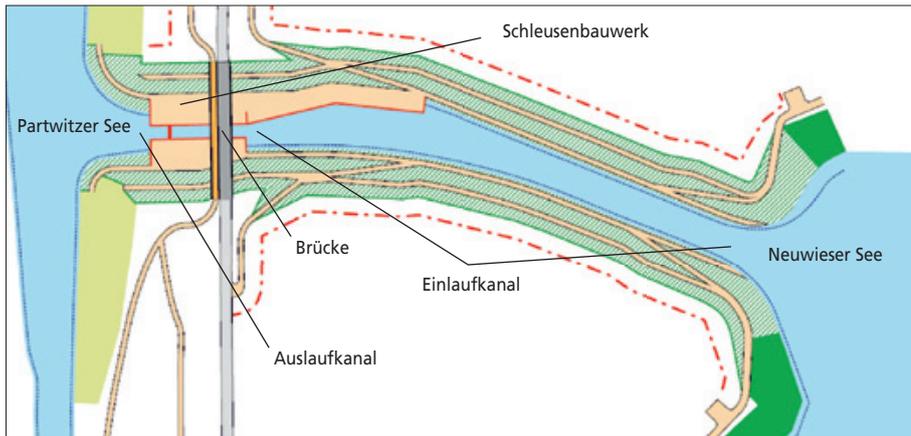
Grundriss Überleiter 6 mit Brücke Staatsstraße S 234 [1]
